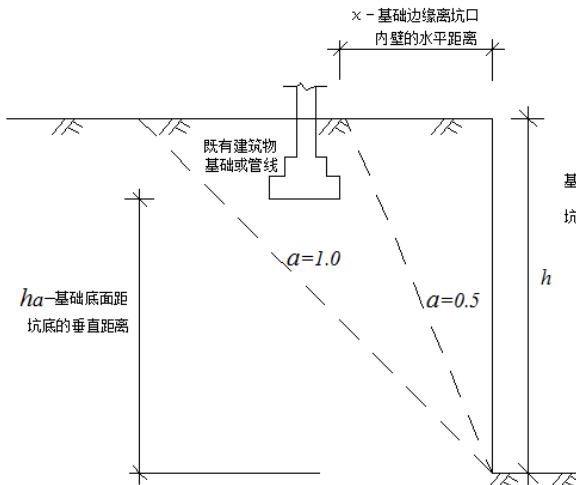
相邻建筑基础与基坑相对关系示意图
